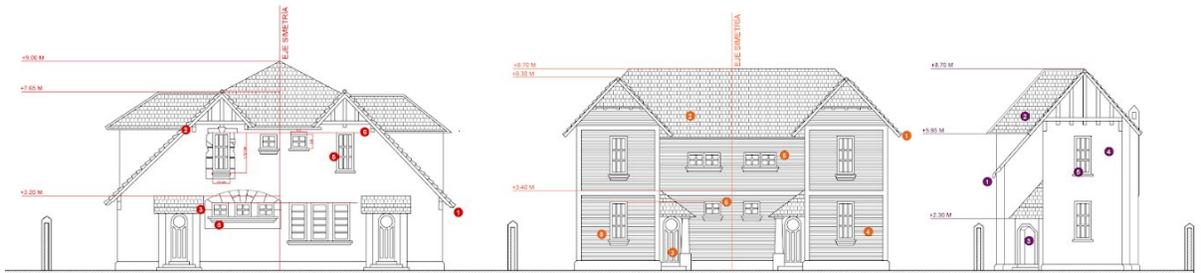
Levantamiento fachadas ZCH Conjunto Calle Triana. Fuente: Departamento Barrios y Patrimonio
